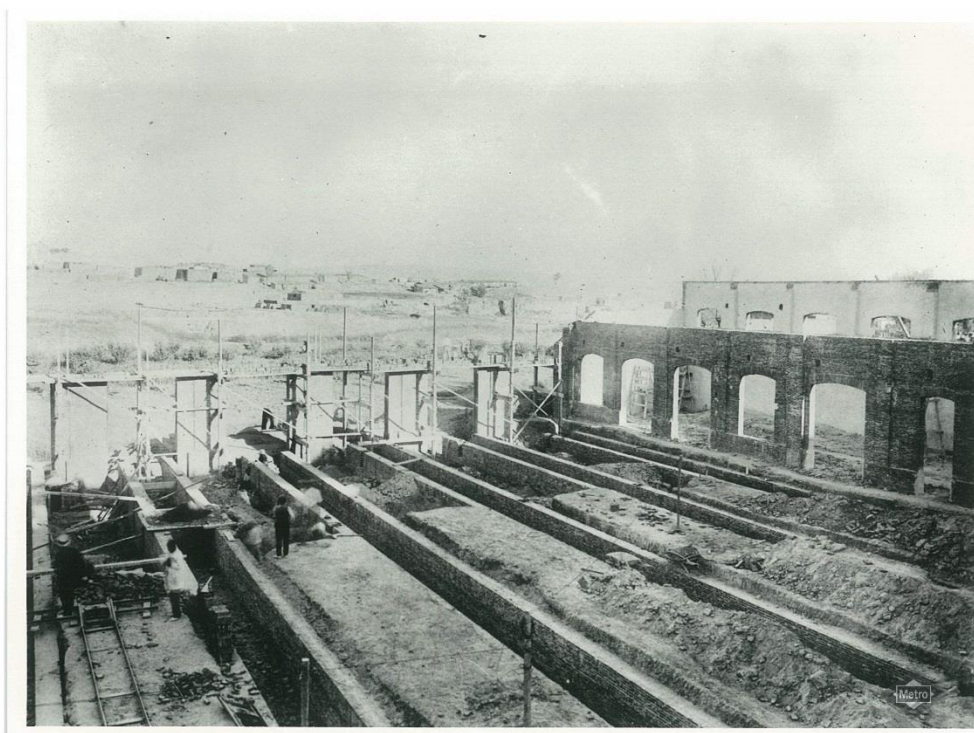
Obras de cimentación de las naves A y B. Archivo Metro
